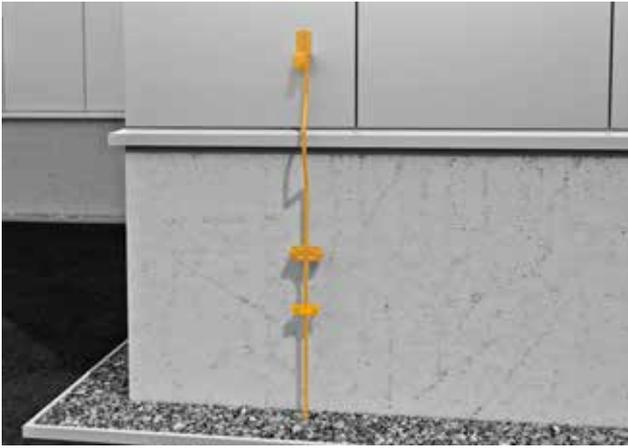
Beispiel: Vertikale Fassadenelemente
